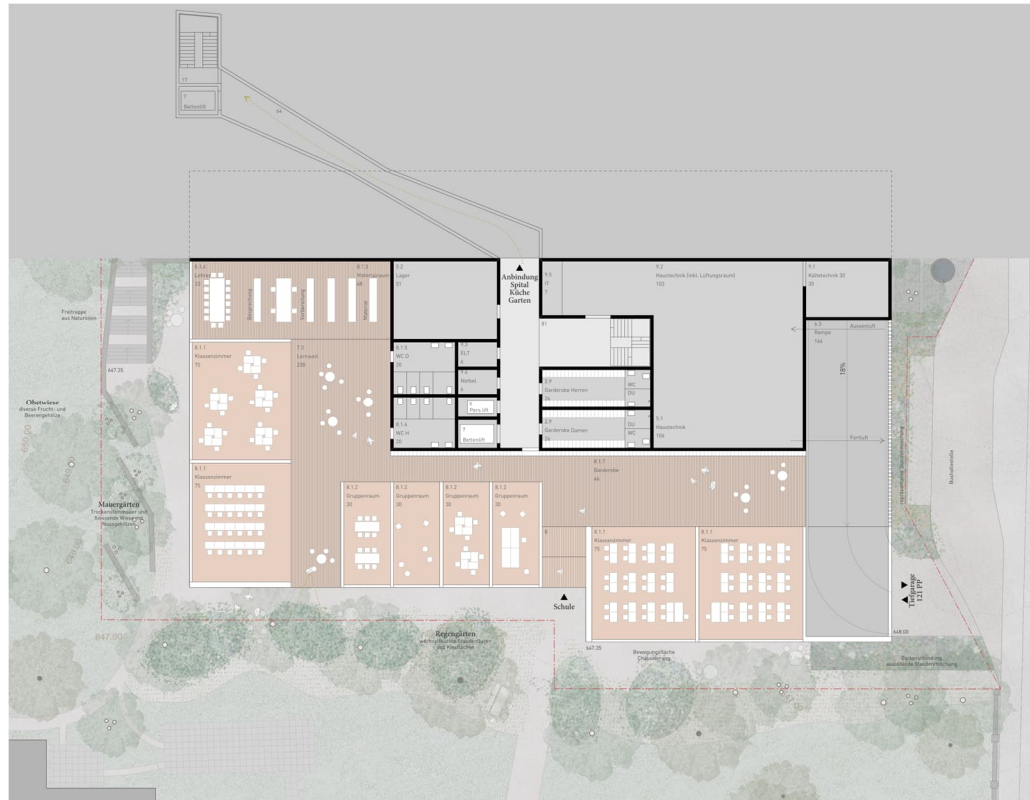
Grundriss Sockelgeschoss Domino (massstabslos)
